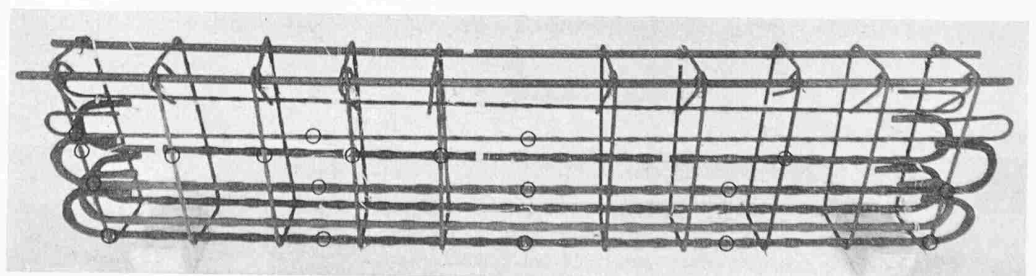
Armierungsgerüst der Balken, Typ B (Orthogonalarmierung)
